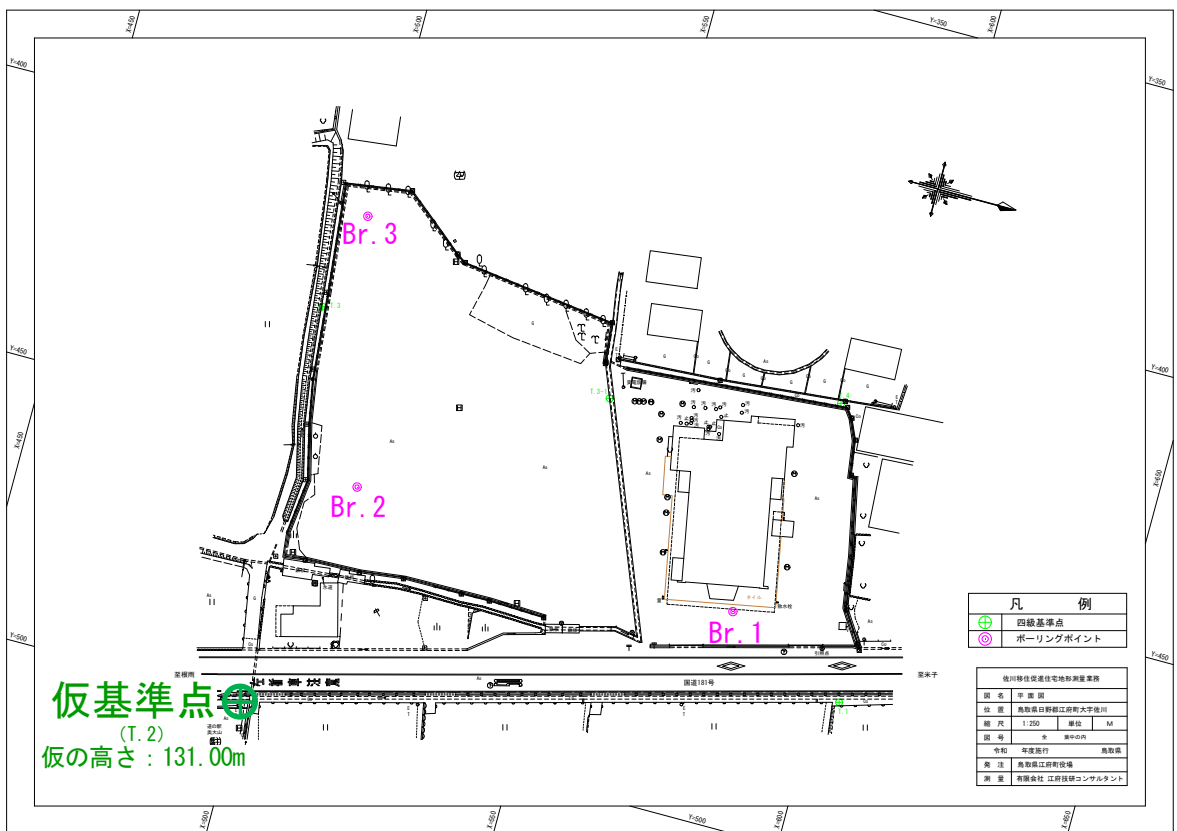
ボーリング調査位置と仮基準点の位置 (A1 1/250 平面図)
